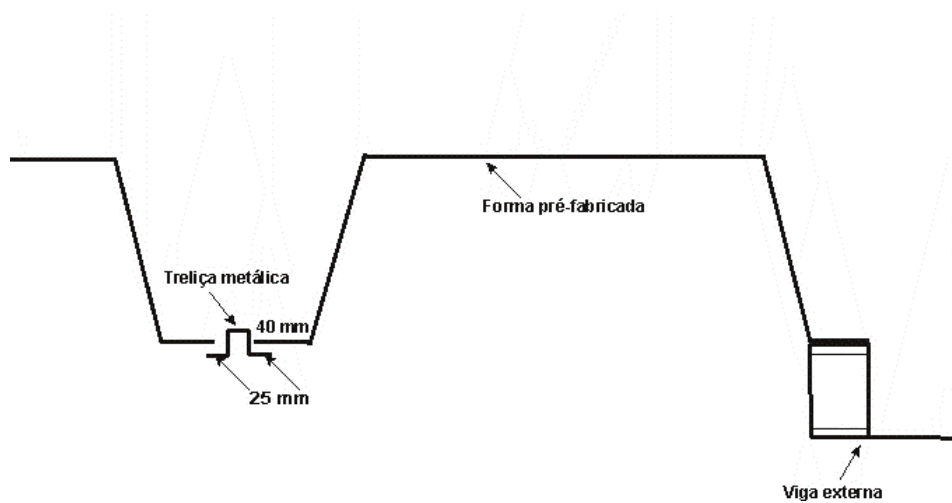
Detalhe do local de apoio da forma pré-fabricada sobre trelça metálica. Belo Horizonte, 2007
